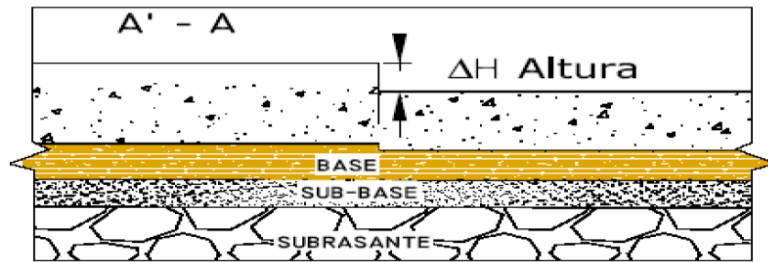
Vista en perfil: Detalle del Escalonamiento.
